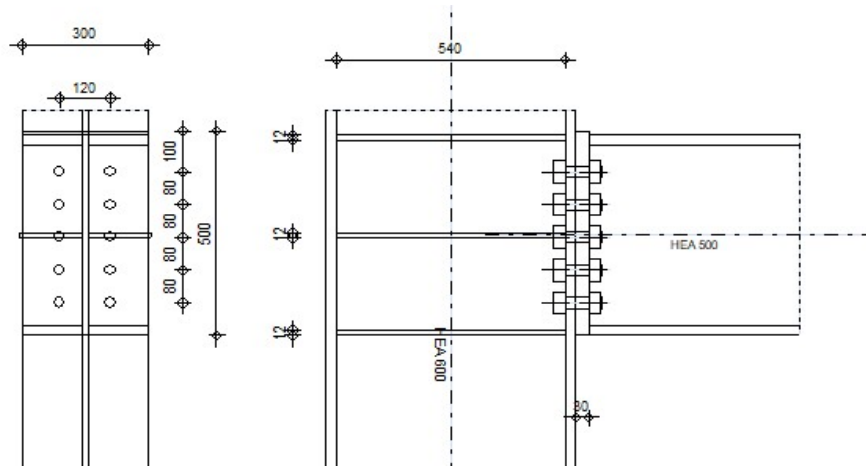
Disposition constructive de L'assemblage poteau poutre
